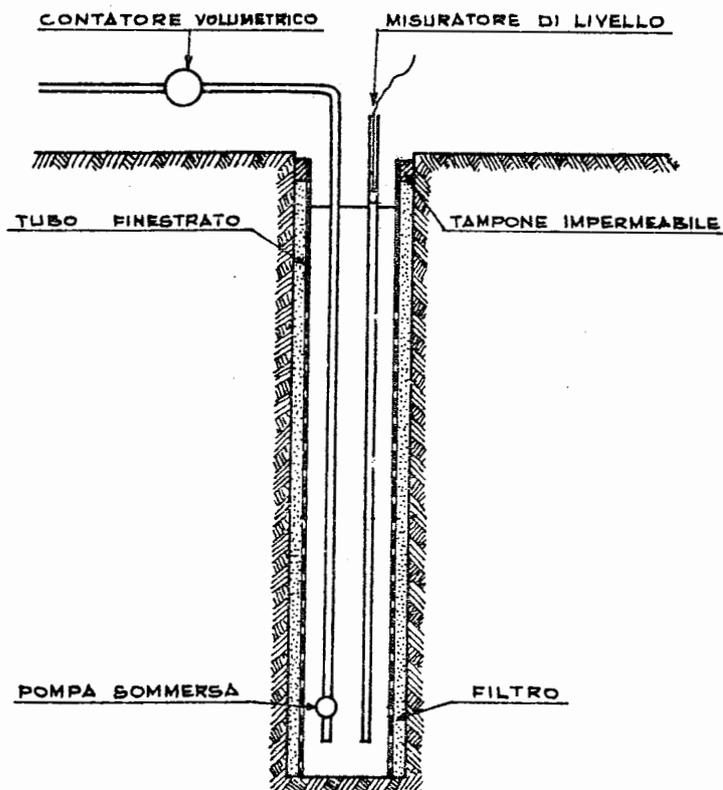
POZZO ATTREZZATO PER PROVA DI EMUNGIMENTO (da H. JOSSEAUMA)
